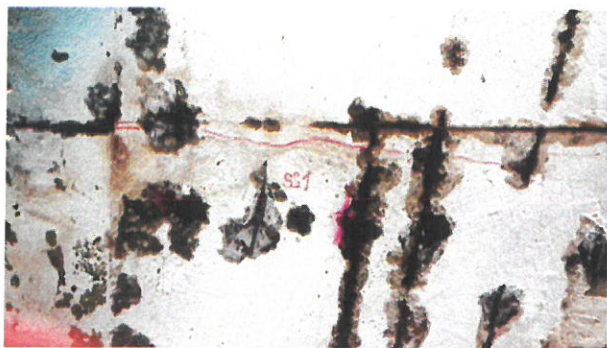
Kondenzovaná voda na spodním líci, koroze prutu betonářské výztuže.
